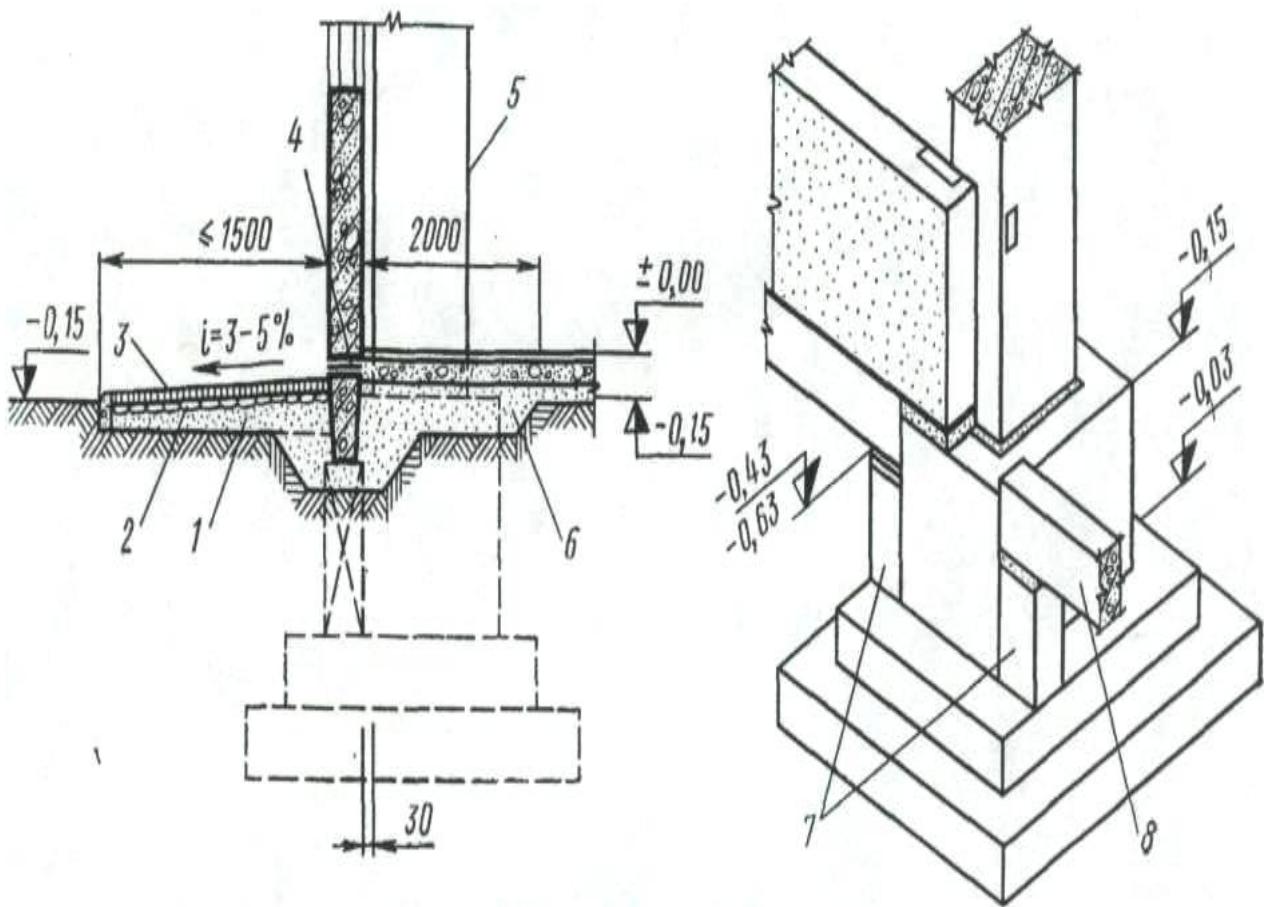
Деталі фундаментів крайнього ряду колон:
